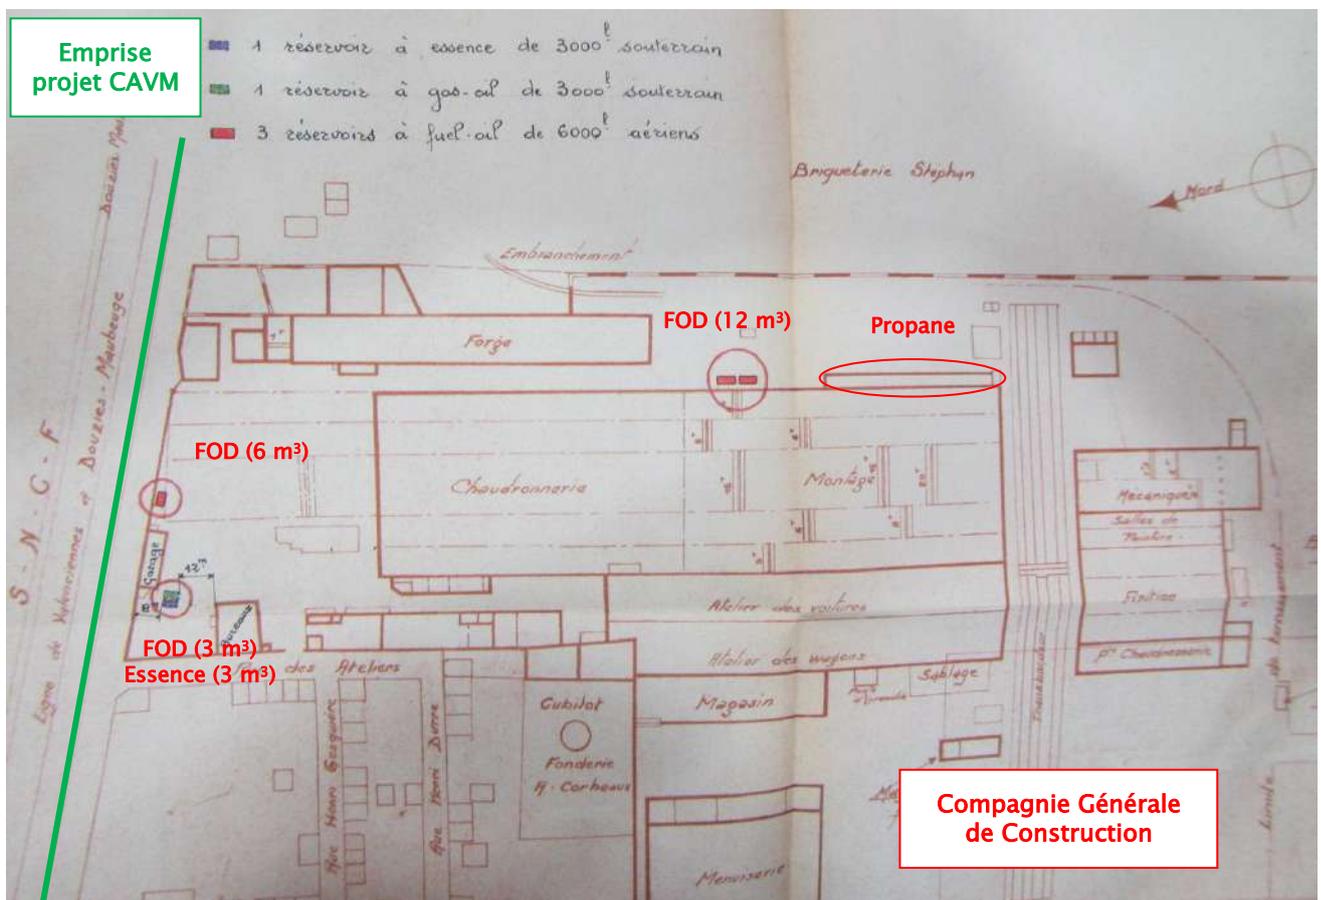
Plan masse du site de la Compagnie Générale de Construction (non daté)
